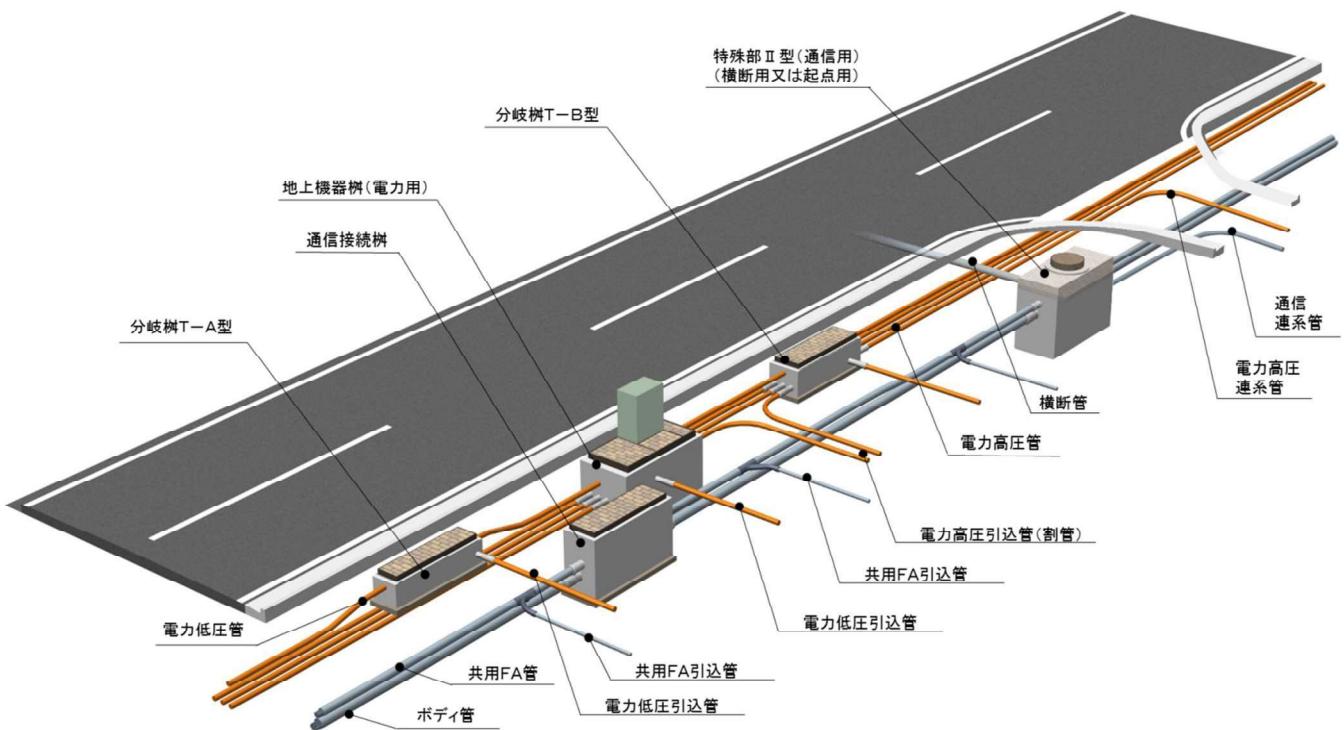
単管路方式・共用 FA 方式のイメージ図（平面図）
